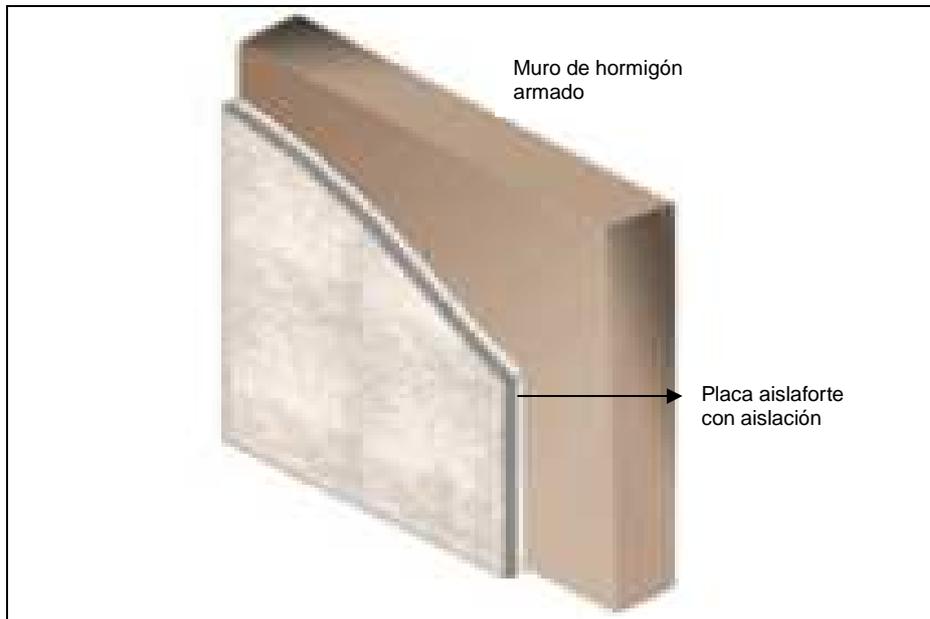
Sistema de aislamiento exterior veture. Placa de fibrocemento se fija directamente al muro.
